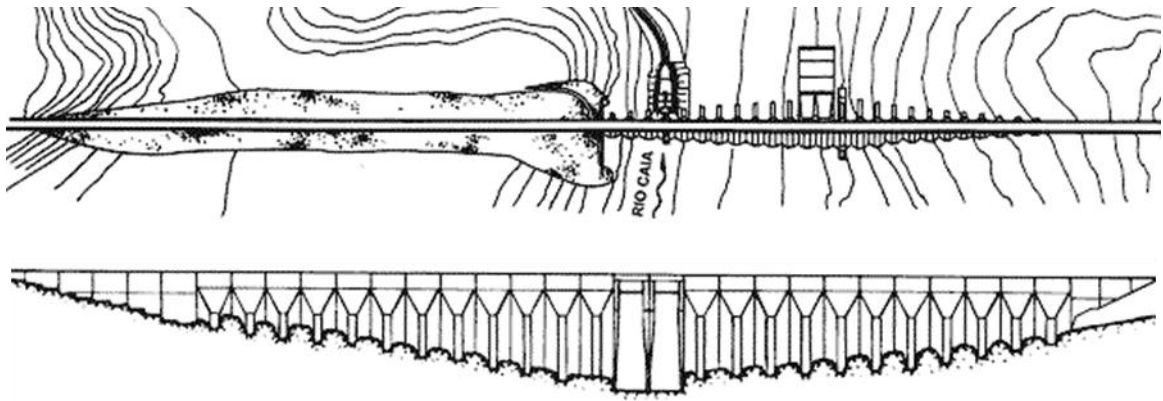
Planta e desenho de jusante da barragem do Caia (Portugal, 1967) [91]
